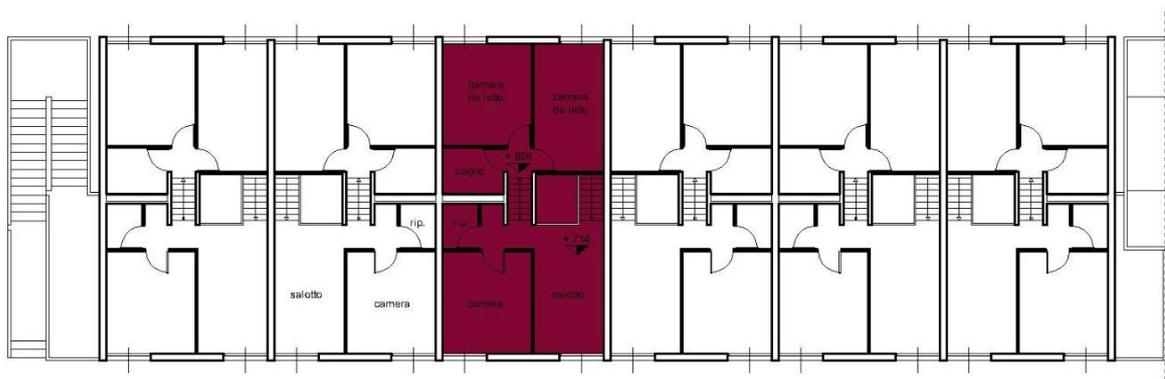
Pianta dell'appartamento 12 - 2 di 2
